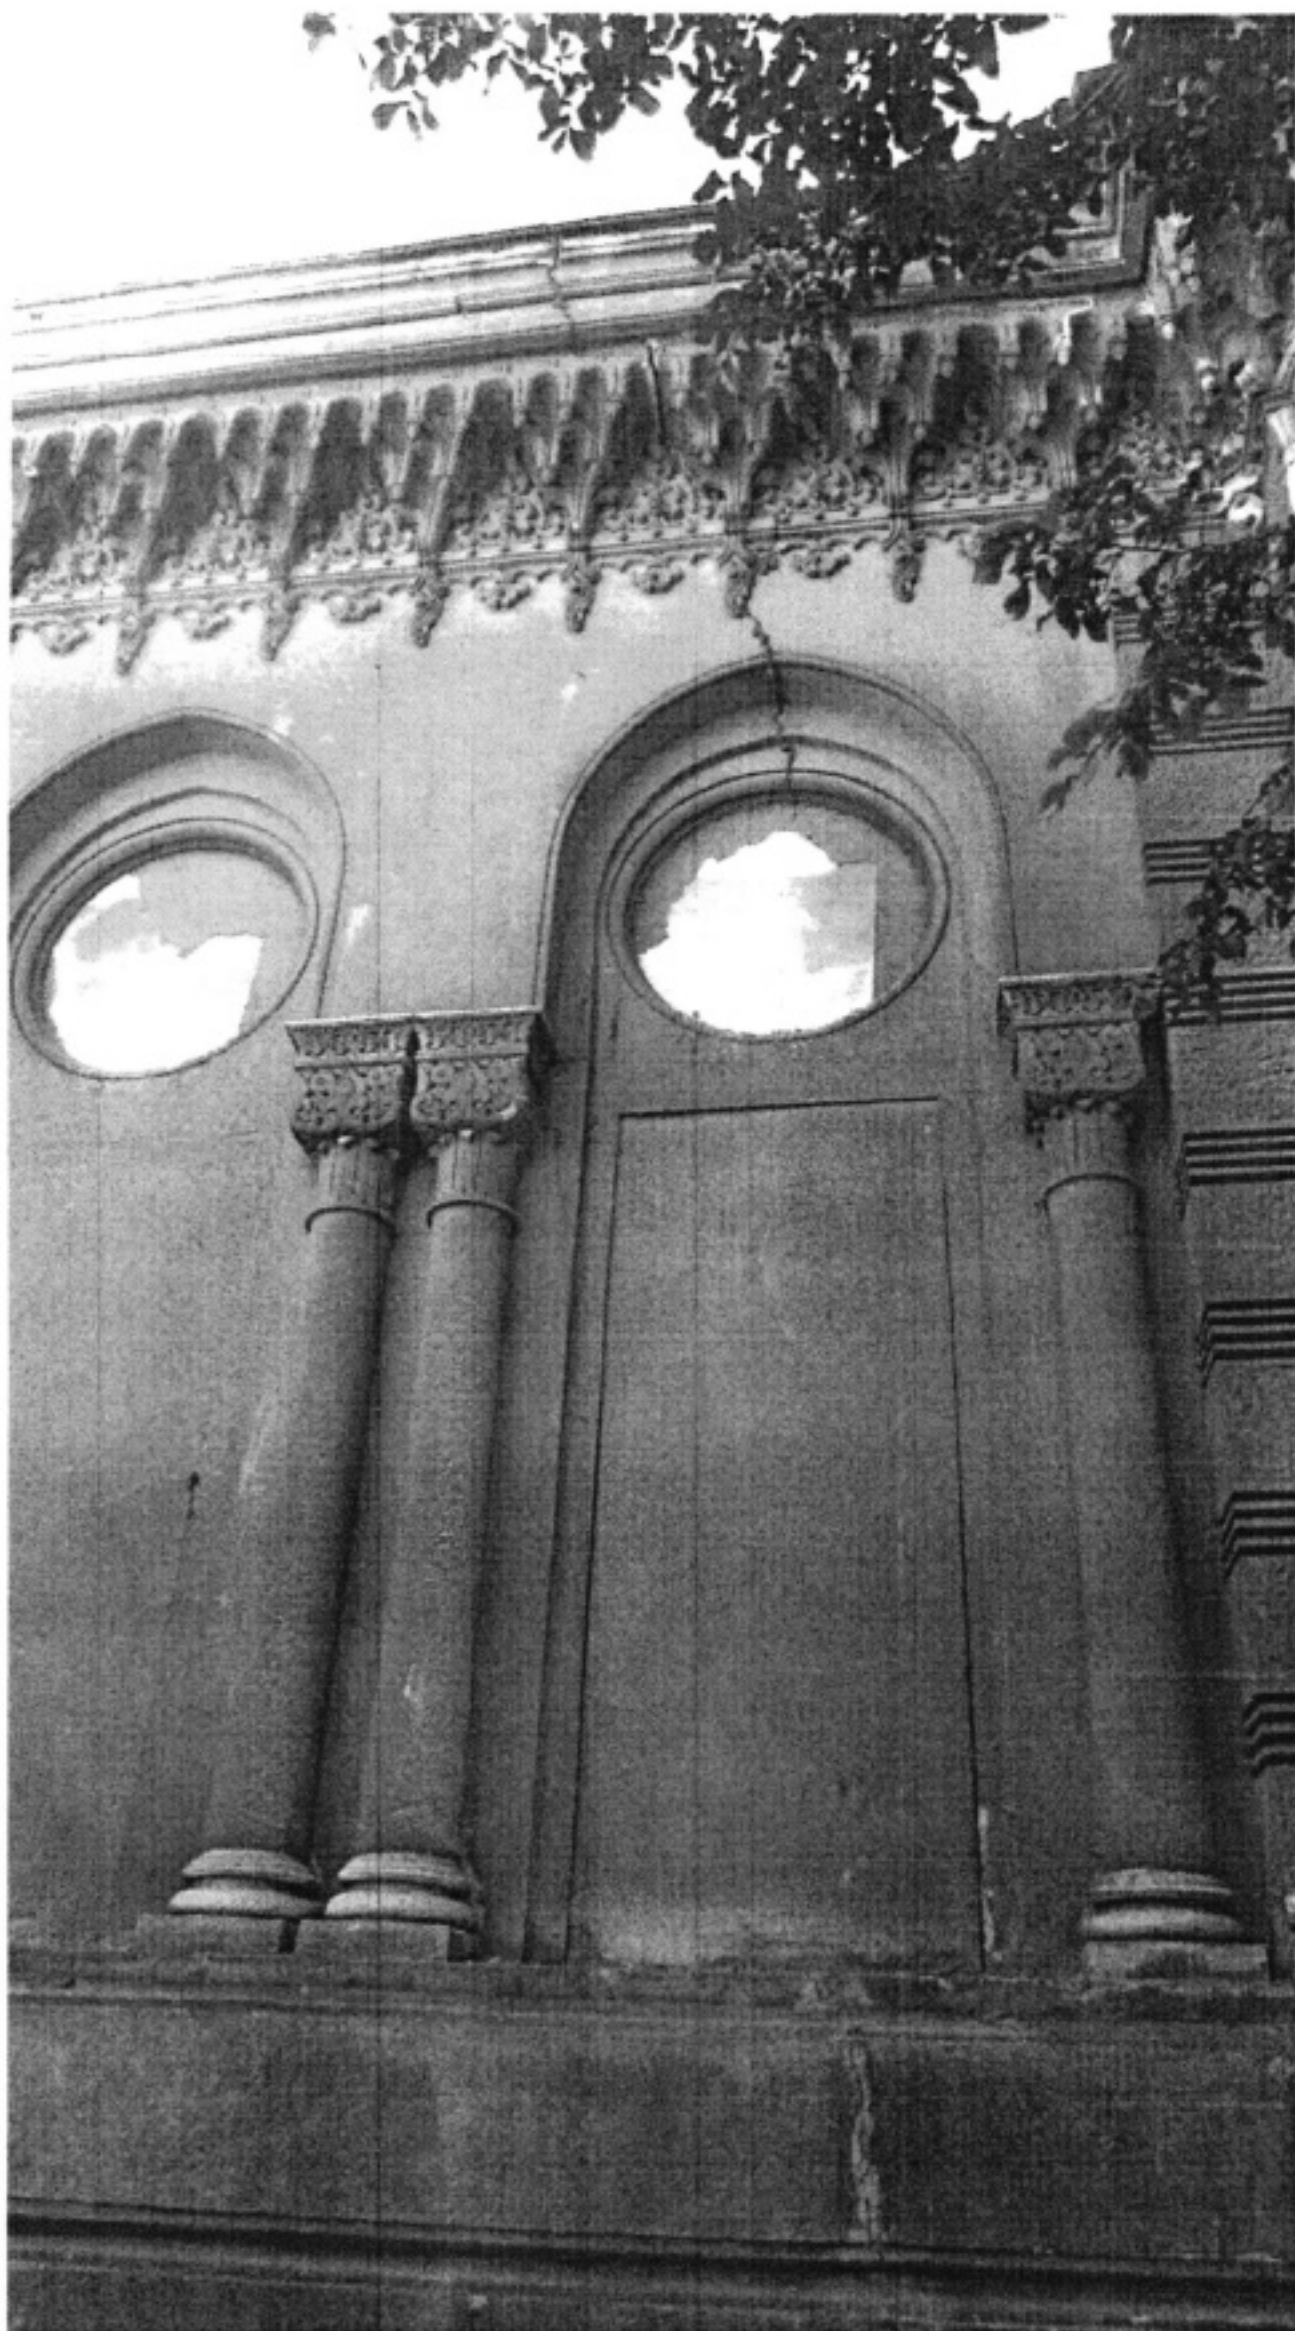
Фрагмент зовнішньої стіни з вертикальною тріщиною з шириною розкриття до 7.0 мм на всю висоту будівлі.
